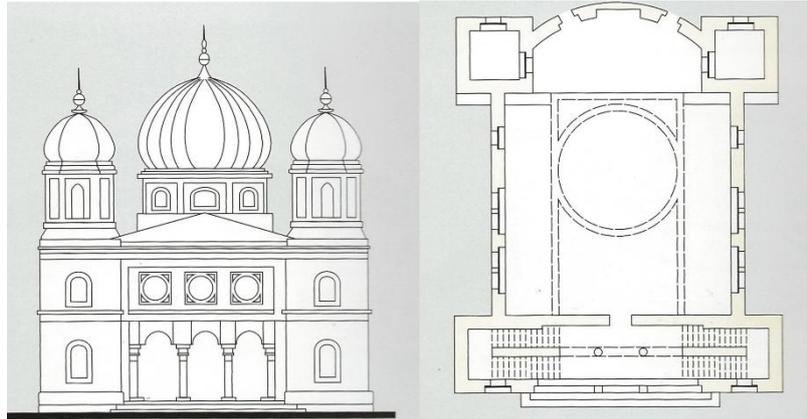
Entwurf Ansicht und Grundriss (1893)
